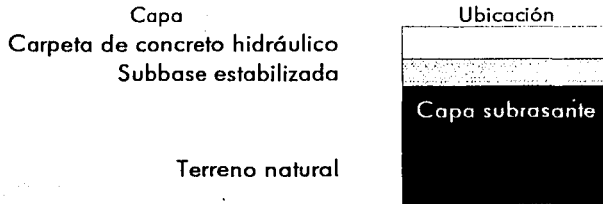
Ubicación de la capa subrasante dentro de la estructura del nuevo pavimento.
